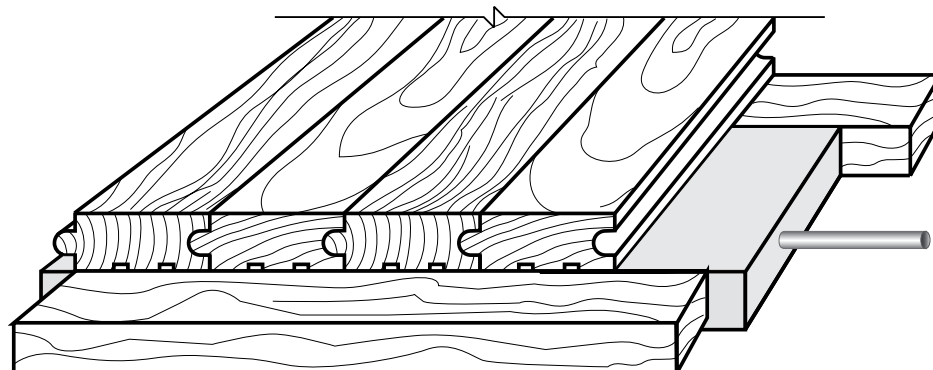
Plancher en bois cloué sur des traverses dans un plancher coulé
